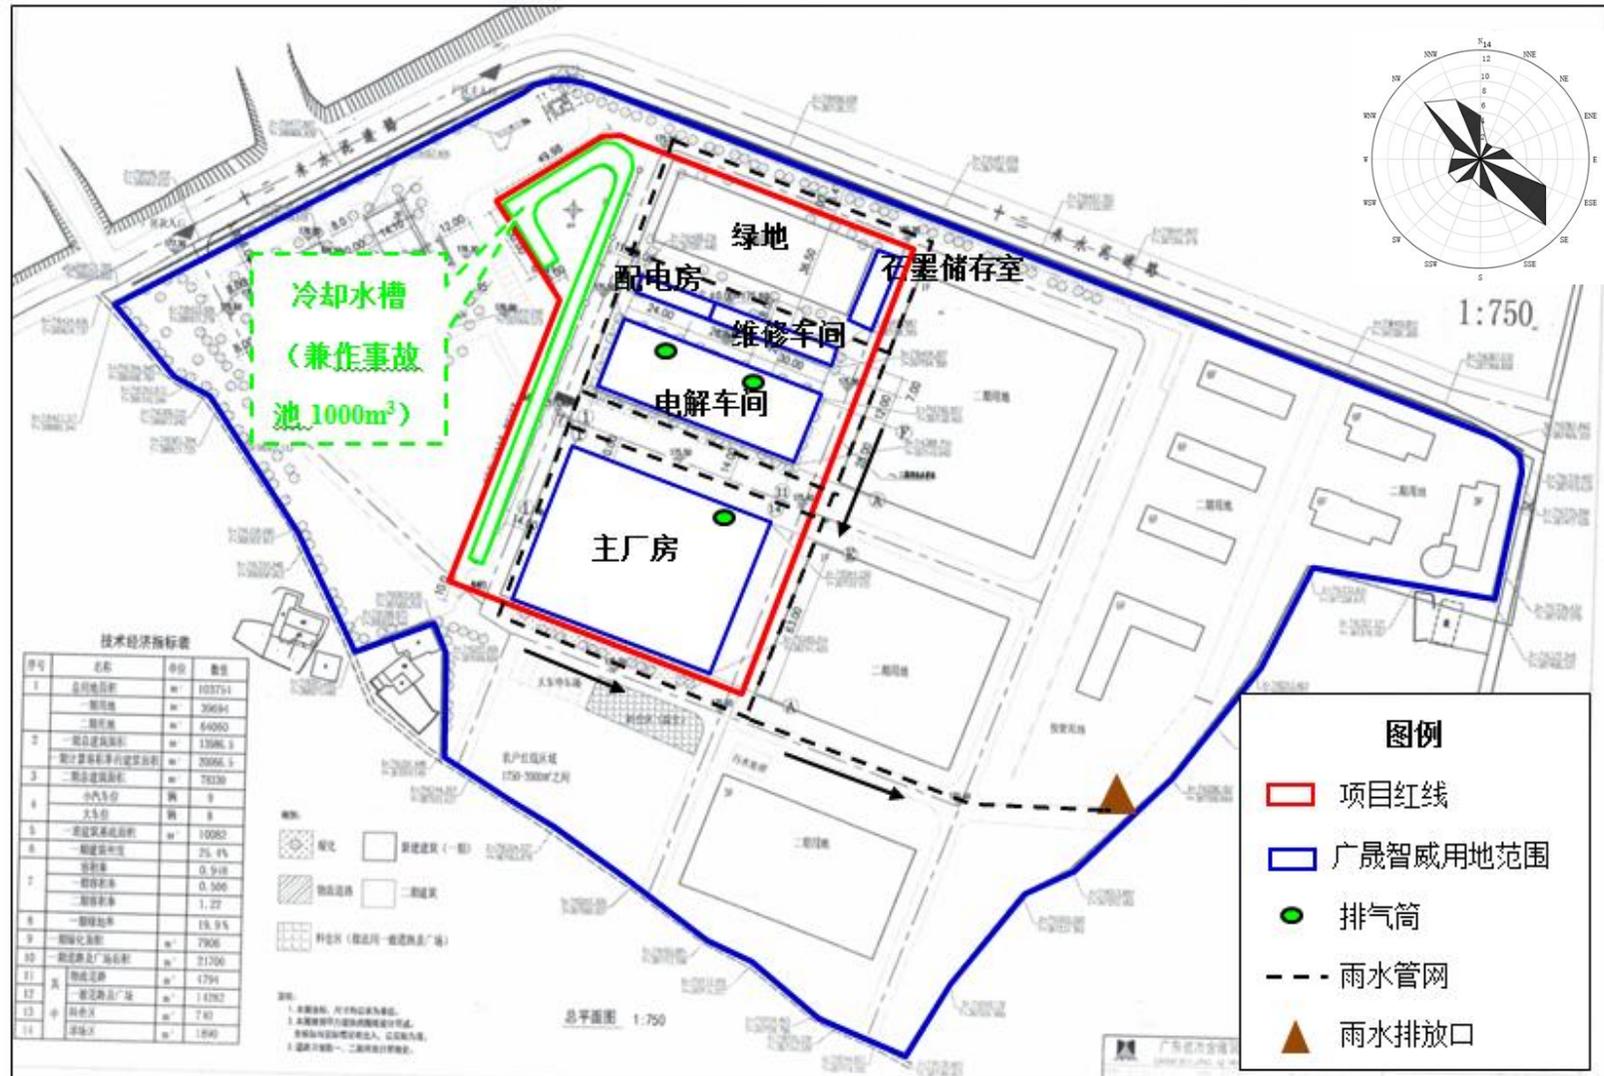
现有项目“镨钕金属技改线”总平面图
